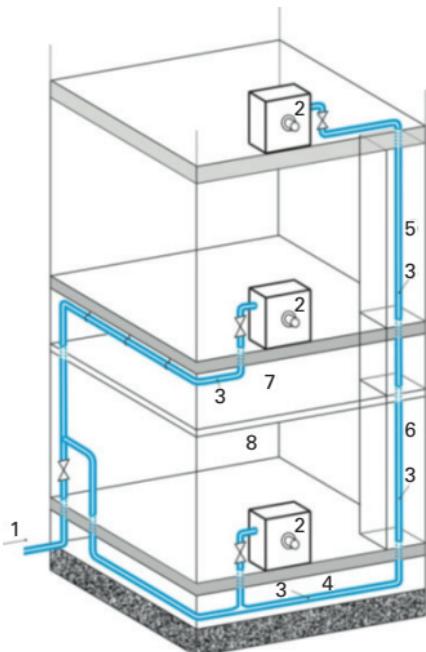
Configuration spatiale 4 : Exemple de tuyaux et de raccords accessibles ou inaccessibles dans une cavité creuse non ventilée ou un conduit de service non ventilé
